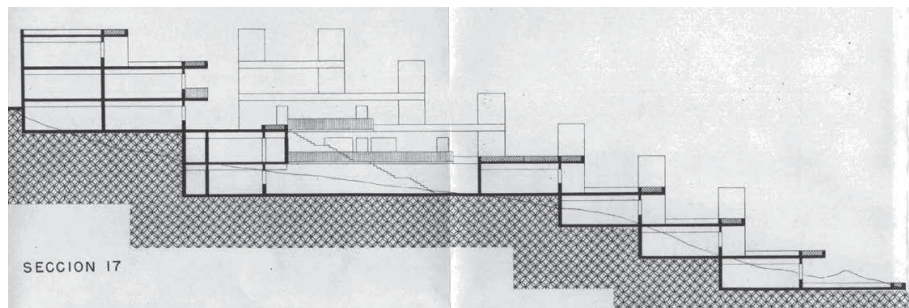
Sección Punta de la Mona. Fuente: plano original legado F. Higuera-Fundación COAM, 1965.
